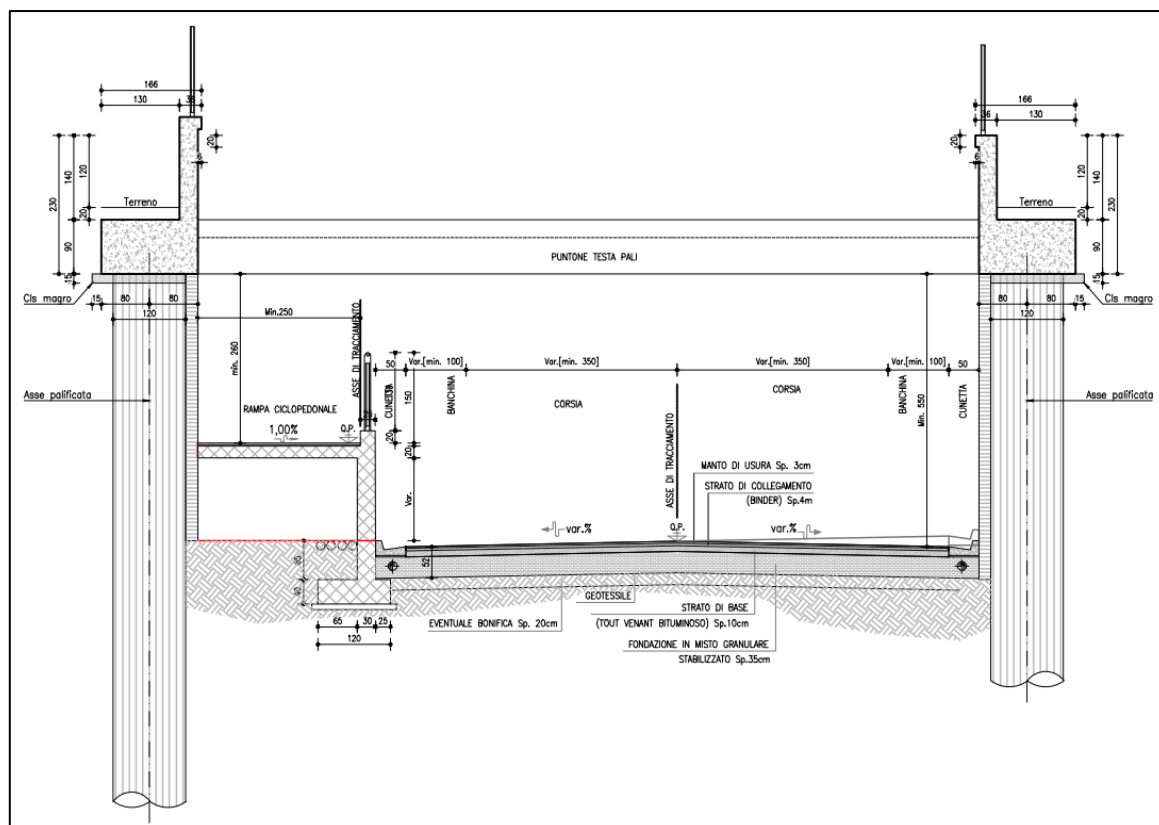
Sezione tipo asse principale con pista ciclopedonale e palificata con puntone testa pali (sezione a cielo aperto)
